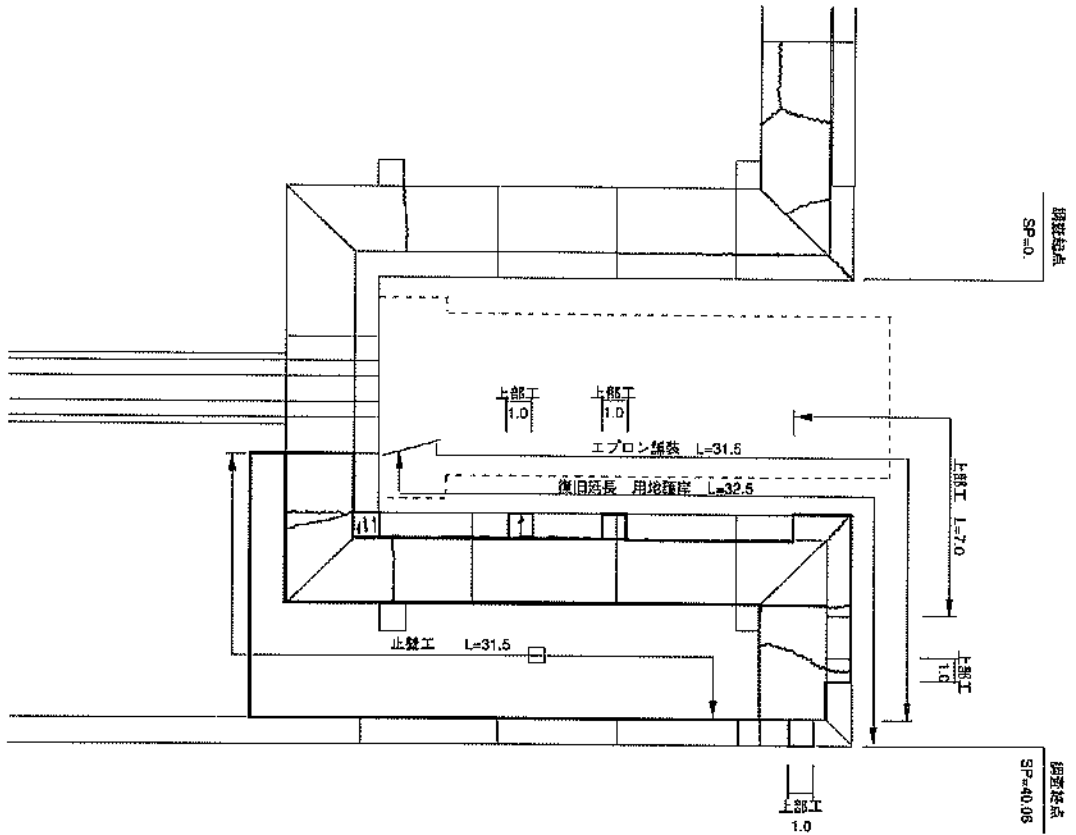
厚岸漁港（湖南地区）大型船揚場標準断面図および被災後の変形図
